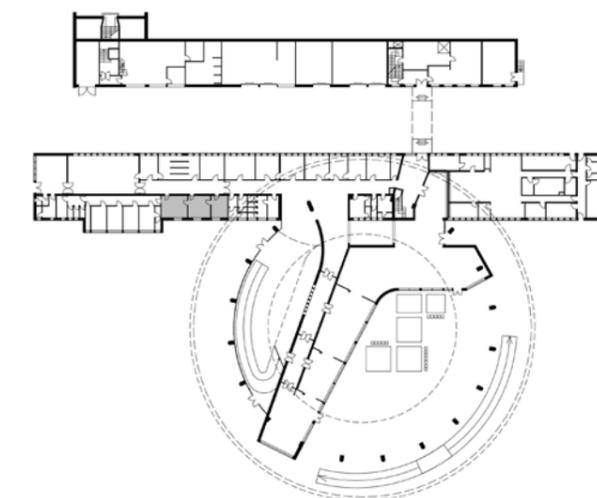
Zimmer 28, 29 und 30 im Grundriss
